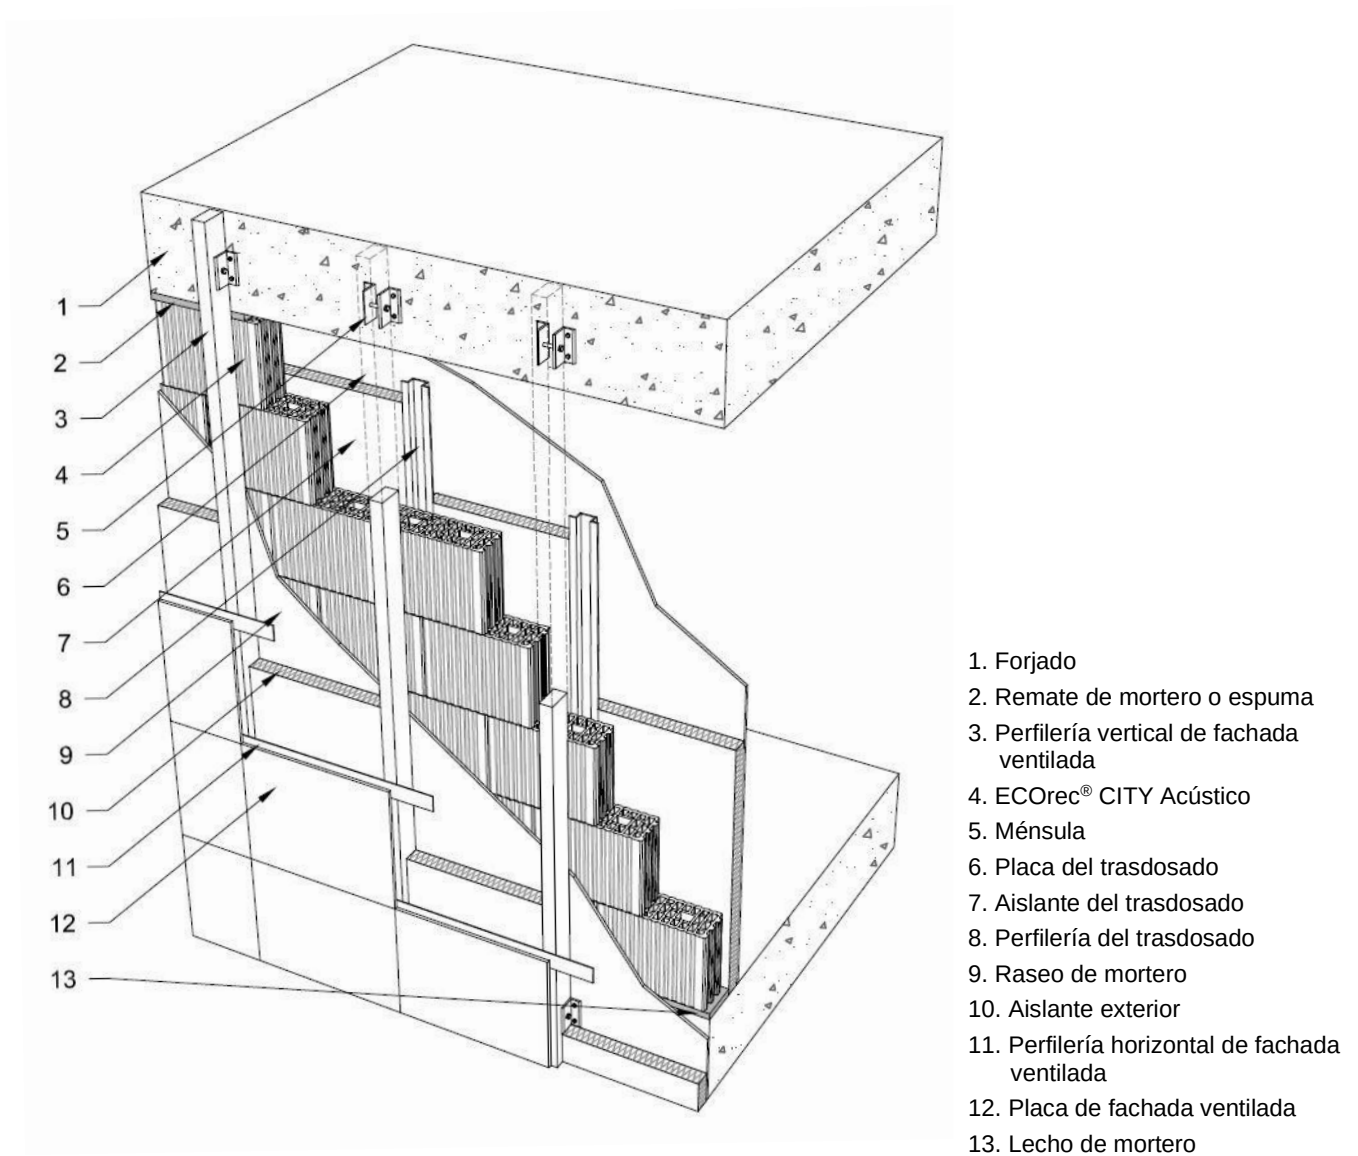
Fachada con sistema ECOrec® CITY (objeto de este DAU) acabado con fachada ventilada y trasdosado genéricos.
